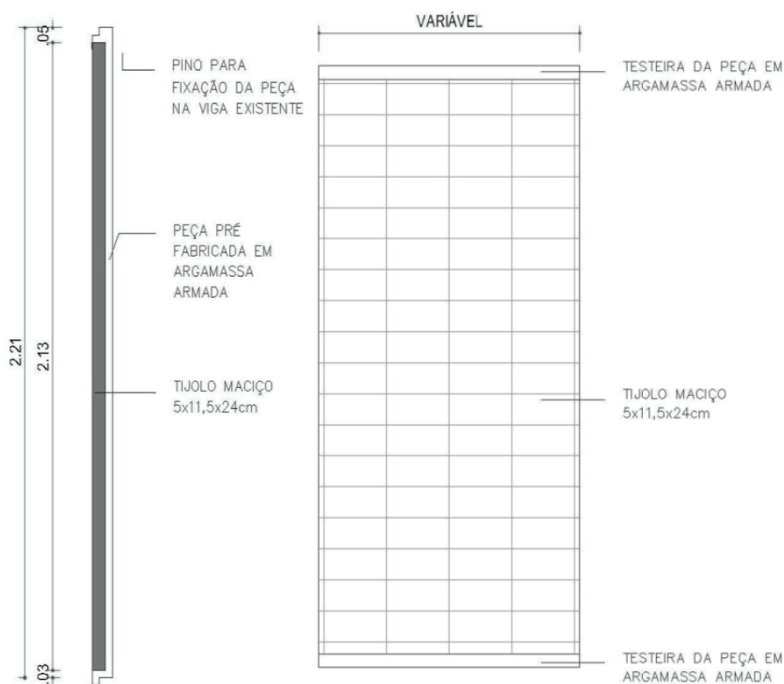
Projeto da peça escolhida para vedação da fachada. Acervo do Autor
